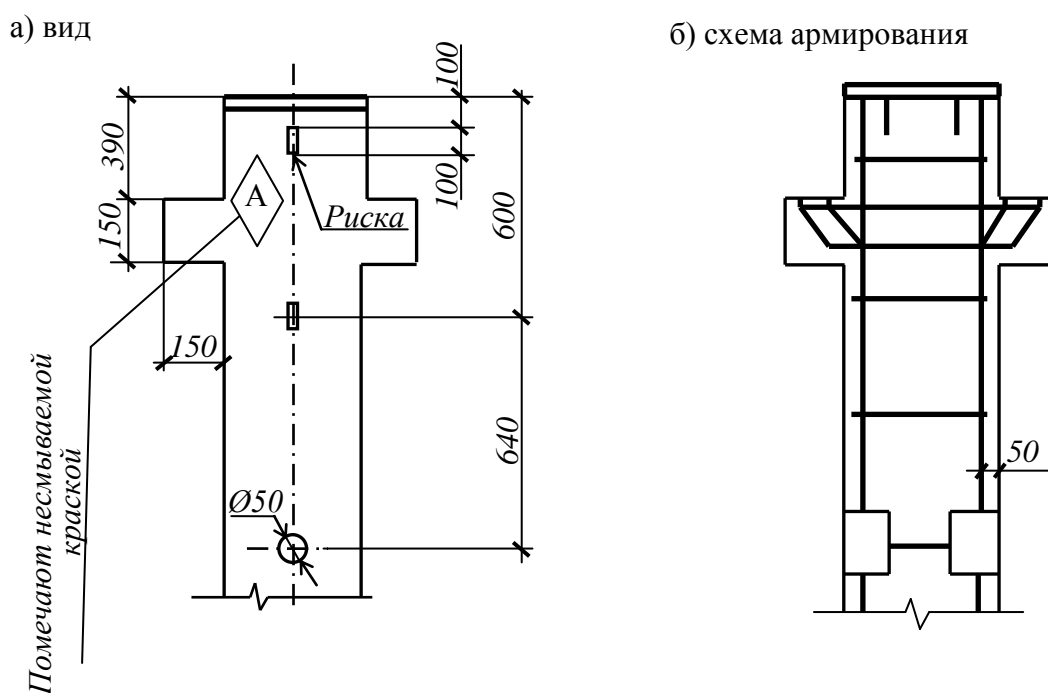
Пример изображения вида железобетонного изделия и схемы его армирования
